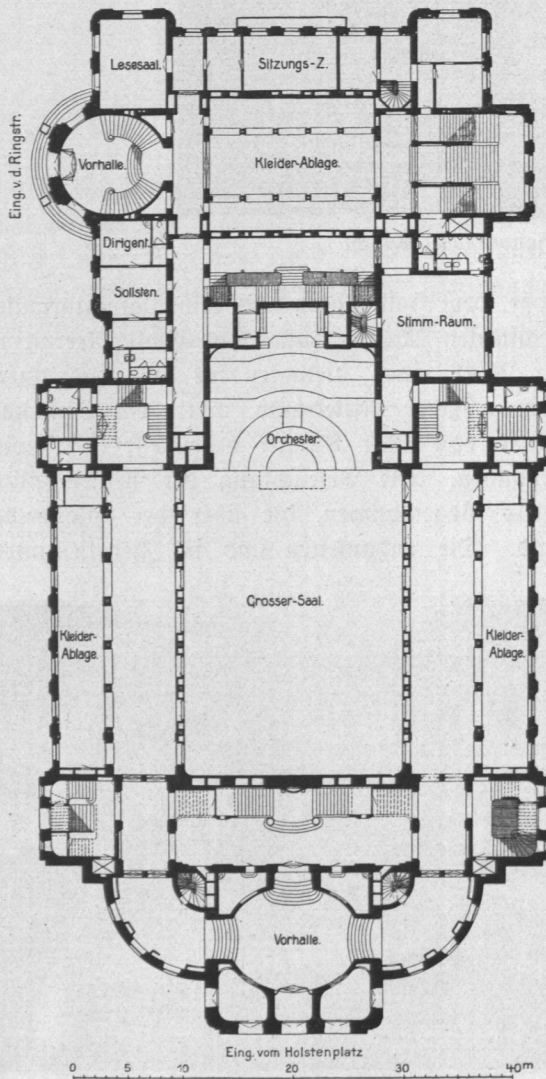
Musikhalle, Erdgeschoß, Grundriß.
